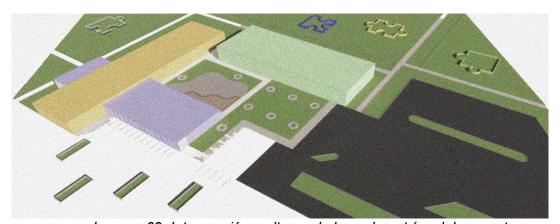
Intersección y alturas de las volumetrías del proyecto
